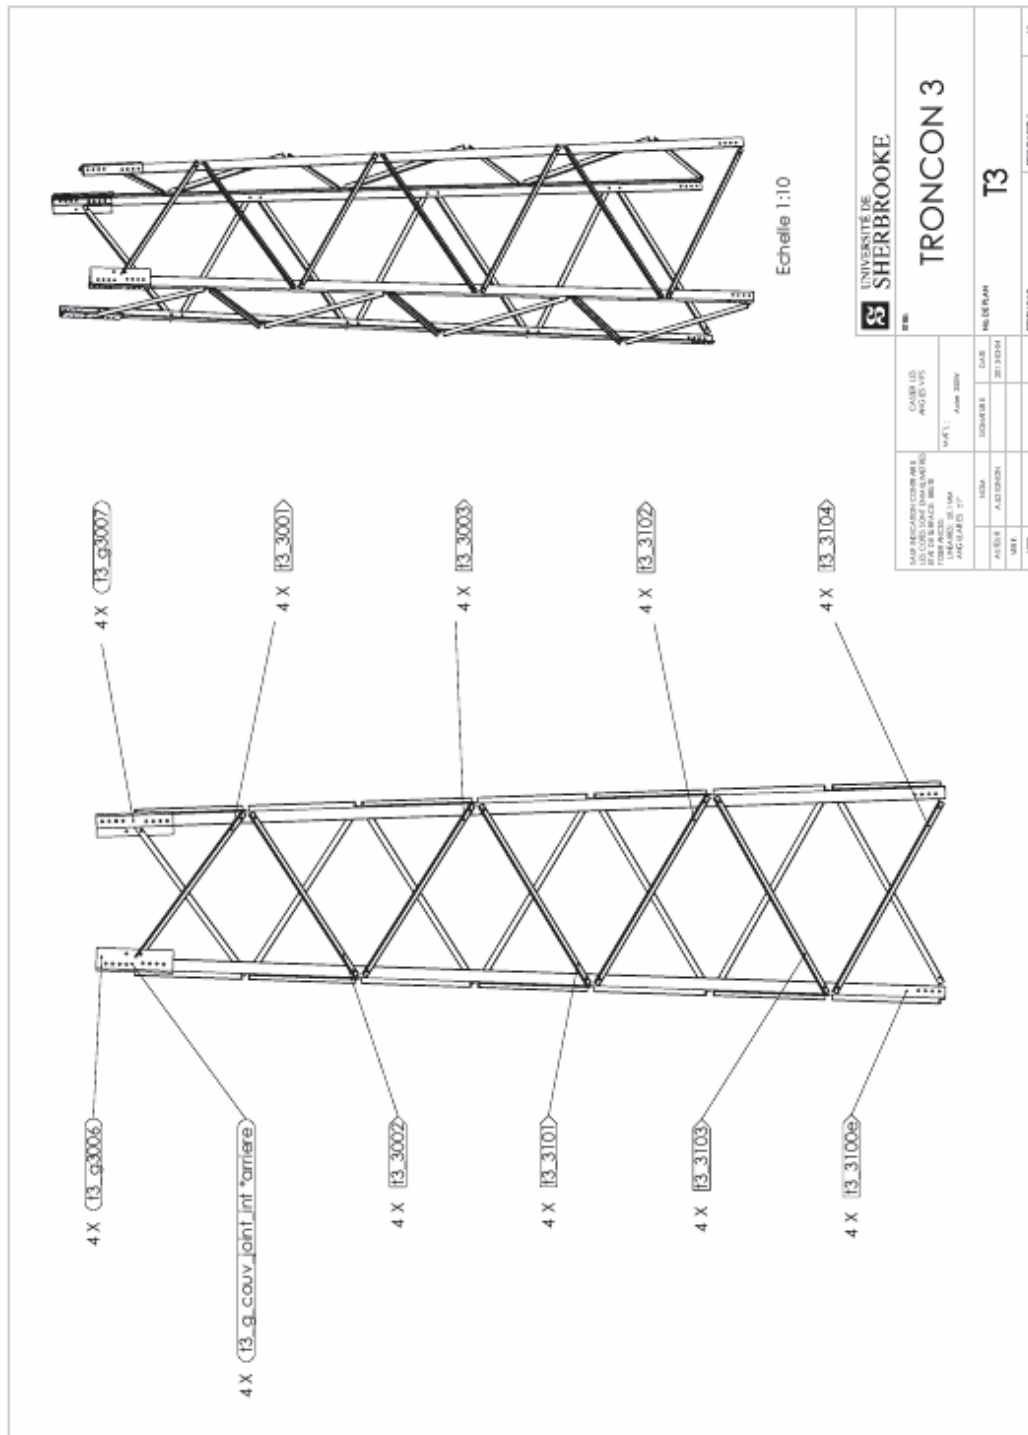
plan d'assemblage de la sous-structure de fût 23 présenté dans Loignon, A *et coll.* [21]
